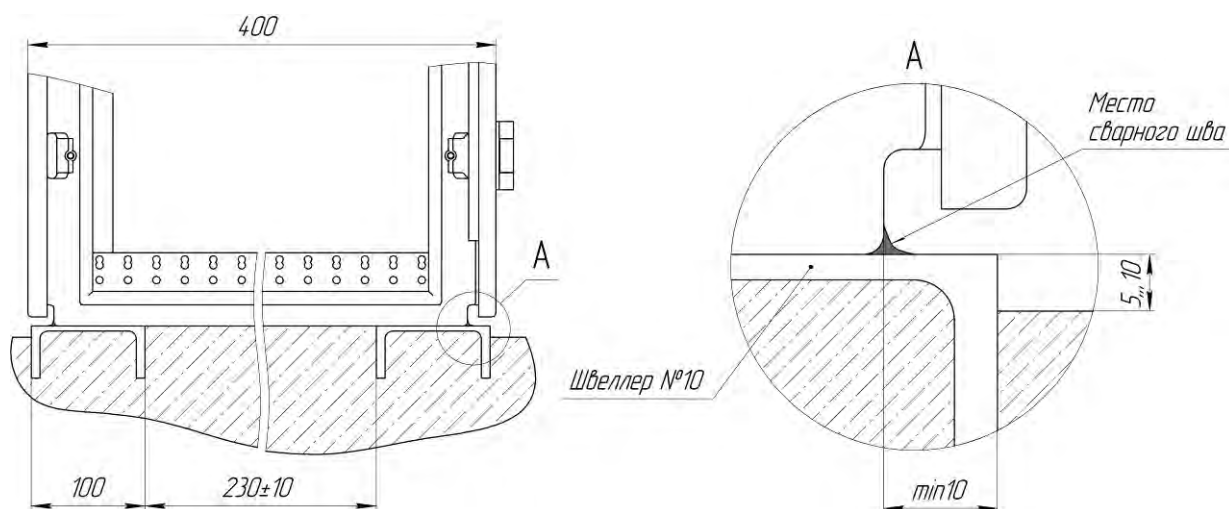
Крепление ПР2020 при помощи сварки.
